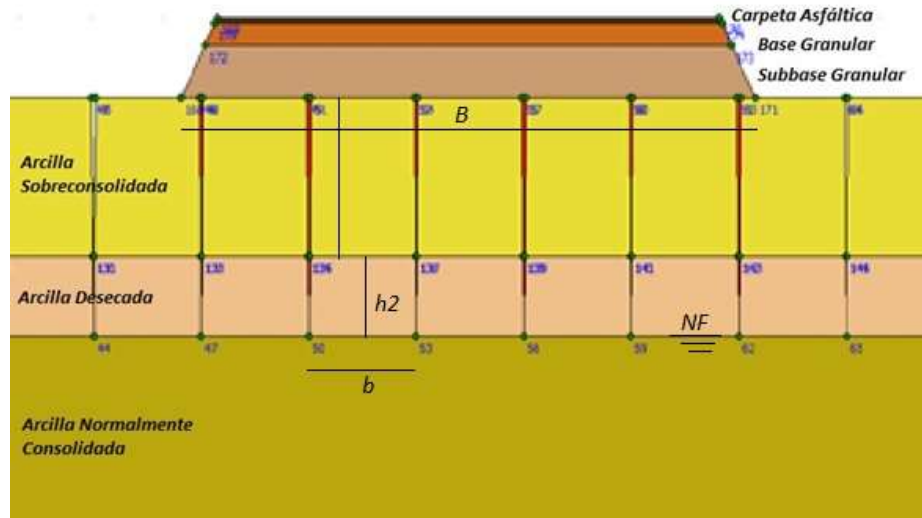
,8. Perfil de simulación de material por debajo de estructura del pavimento (Autor).
